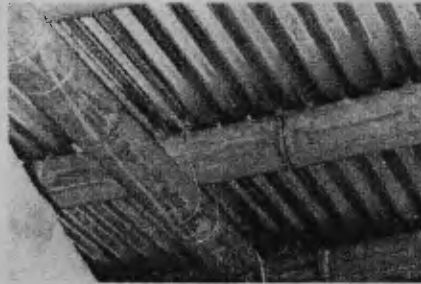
UNION ENTRE TIJERAS Y COLUMNA
